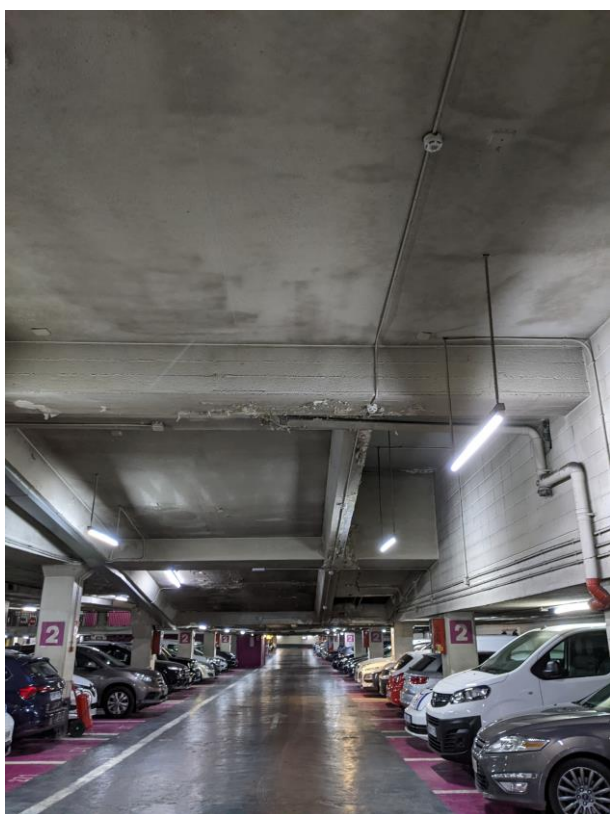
Entramado de bigas apoyo de la rampa de entrada
